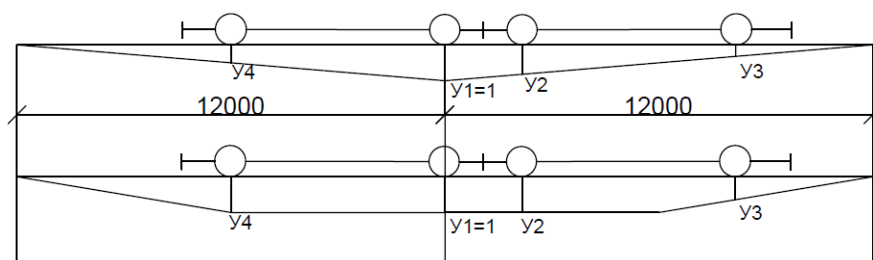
Схема к расчету колонны на крановую нагрузку
